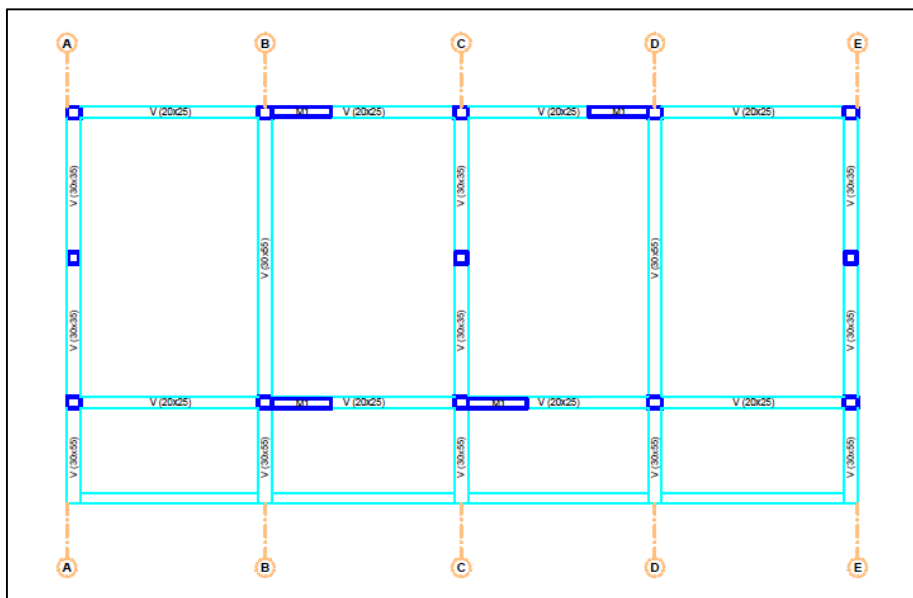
Plano de estructuración con muros de corte propuestos del Módulo B
